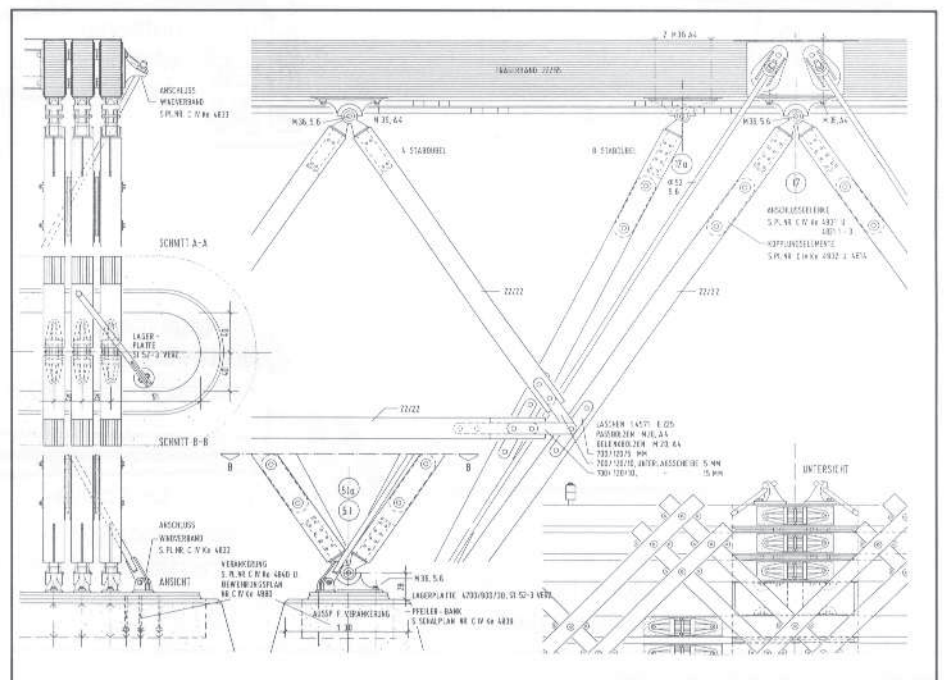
Fachwerkpfiler in Grundriß, Schnitt, Ansicht
